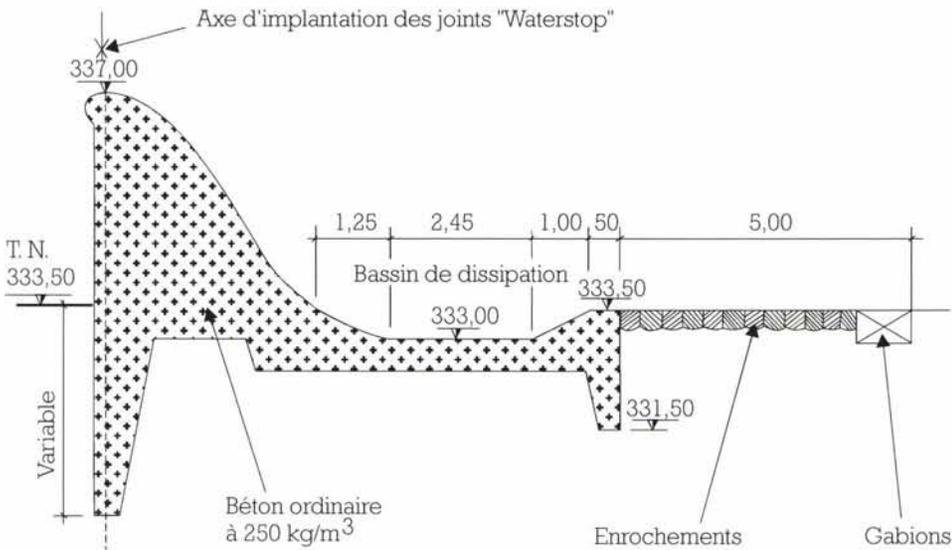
C-2 : Vue en coupe de l'évacuateur du barrage de Tia (d'après [2]). Cf. également la photo 2.2 dans le chapitre 2 du présent manuel
